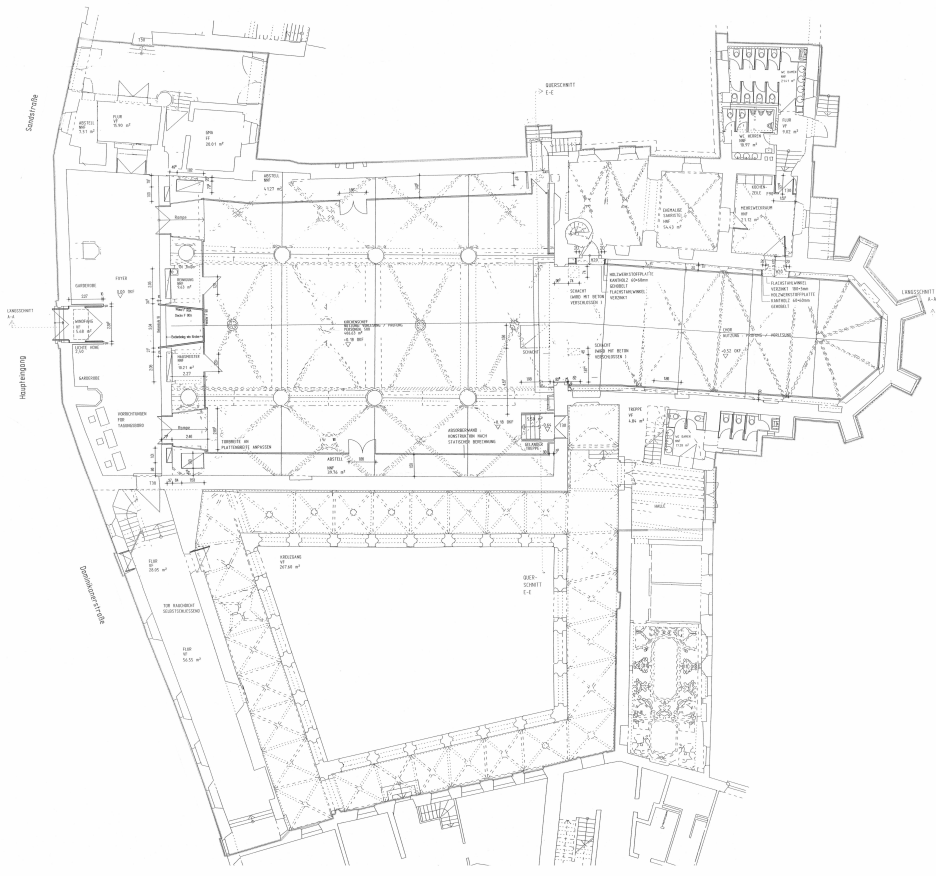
Grundriss der Dominikanerkirche, Erdgeschoss.
